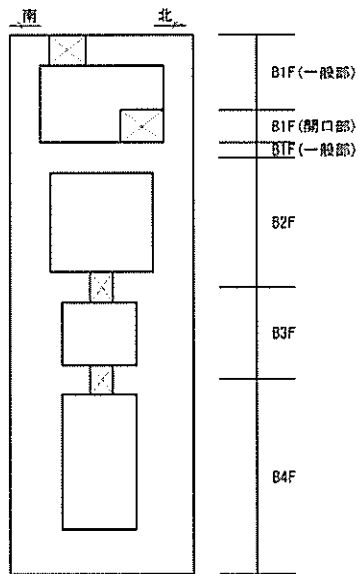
(4) 概略配筋図 (南北方向断面)
